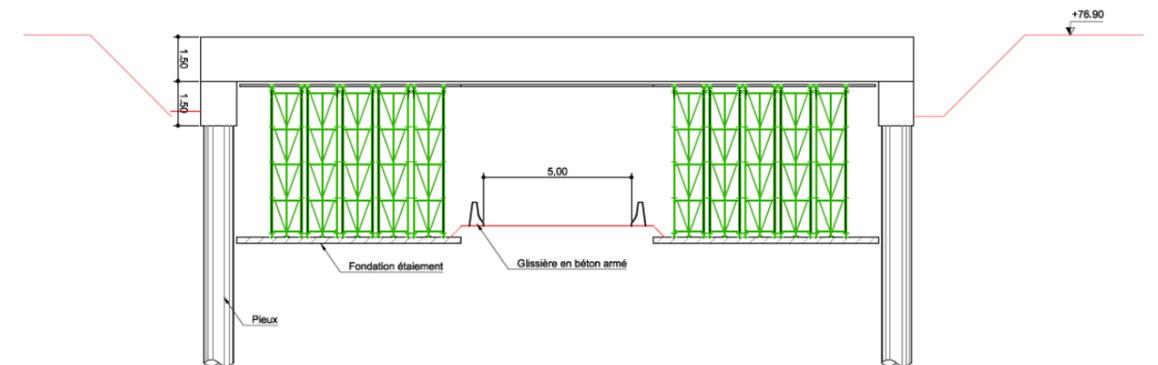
Gare de Fort d'Issy Vanves Clamart – coupe technique de principe
